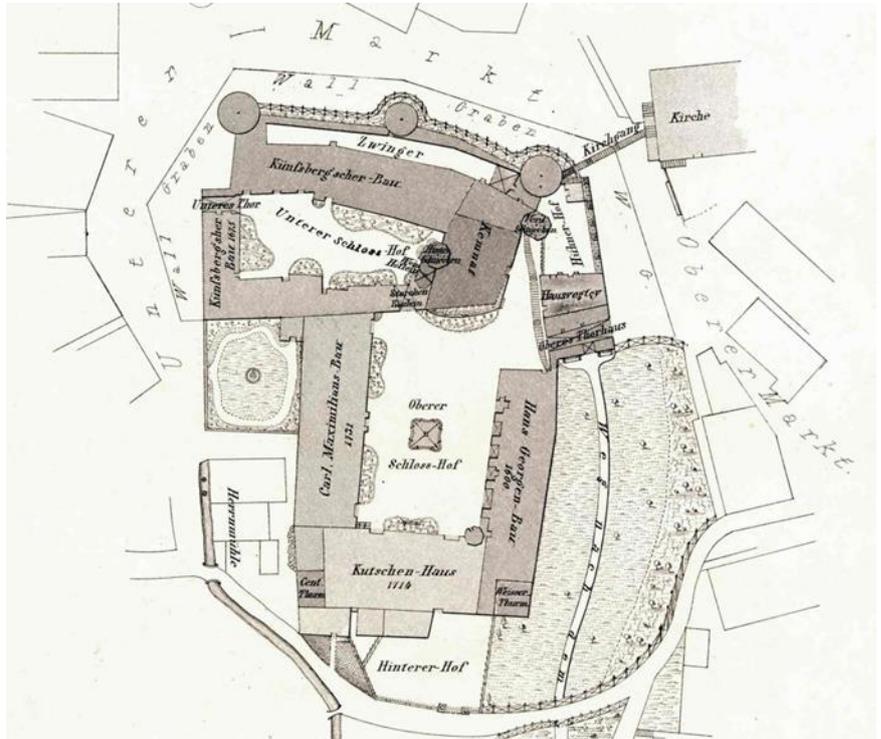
Historischer Grundriss des Schlosses
